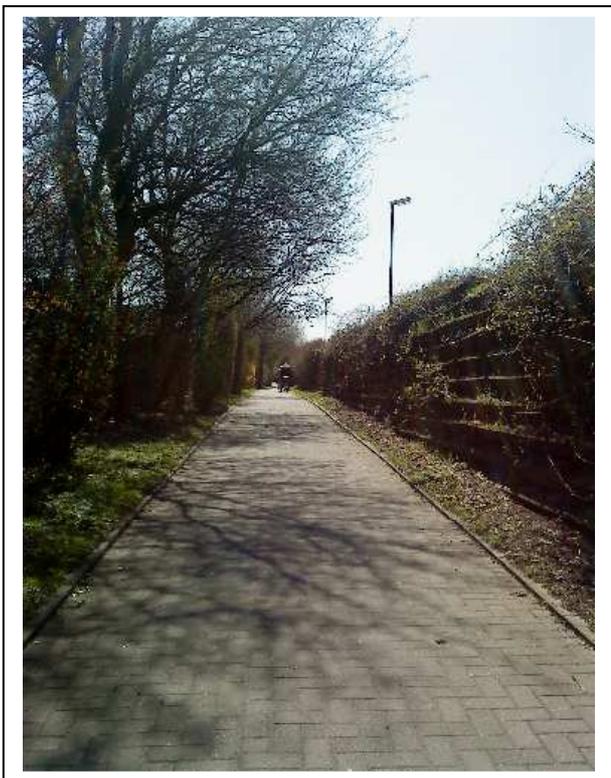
Fußweg und Grünfläche hinter der Lärmschutzwand
